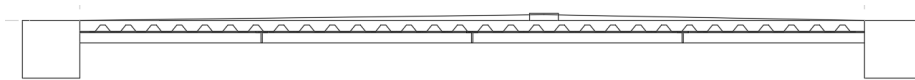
Sección transversal tipo del tablero. (Fuente: elaboración propia en AutoCAD).
